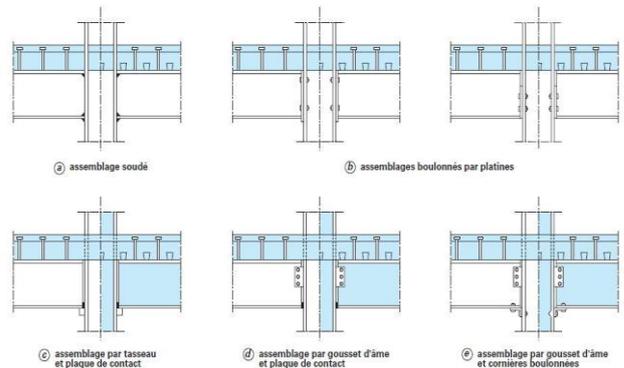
(a, b, c, d, e) – Assemblages de type poutre-poteau pour des ossatures mixtes semi-continues
